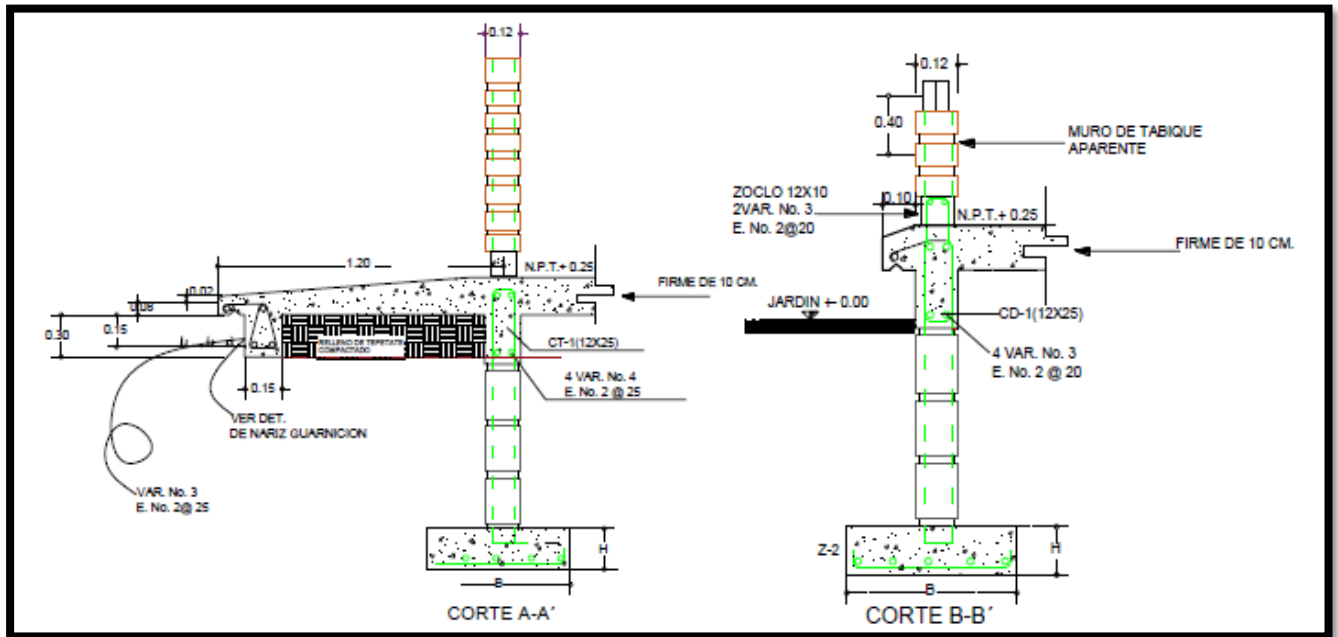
Detalle croquis de cimentación, dimensiones de zapatas y contratrabe, armado, mejoramiento y relleno. Fuente (proyecto ejecutivo.)
